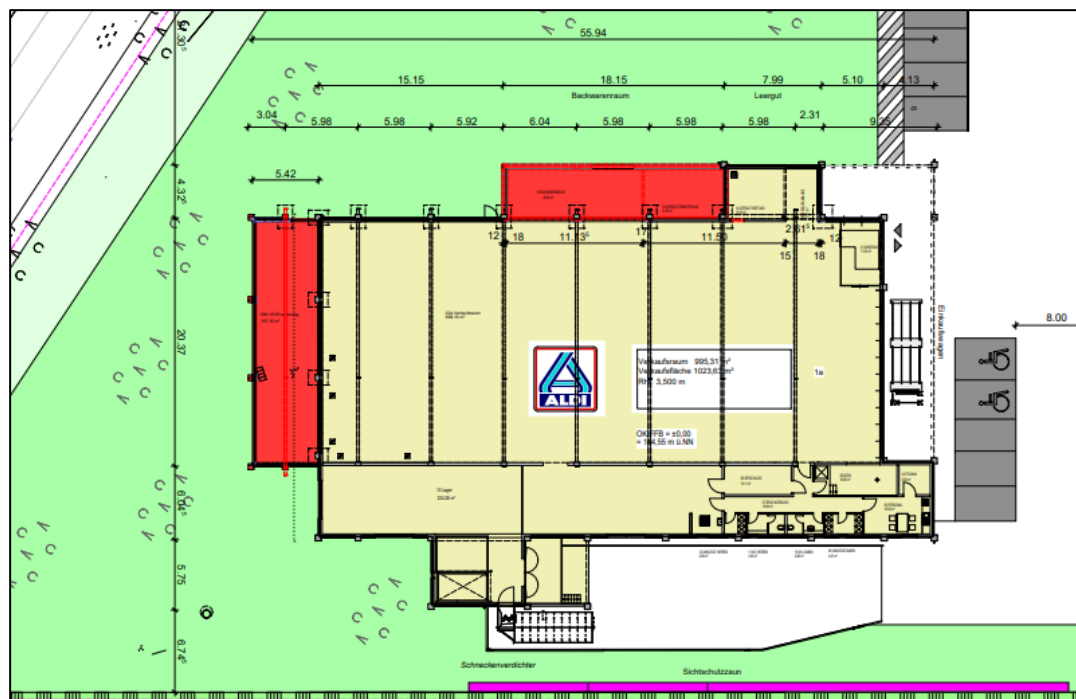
Lageplan / Grundriss des Planvorhabens
